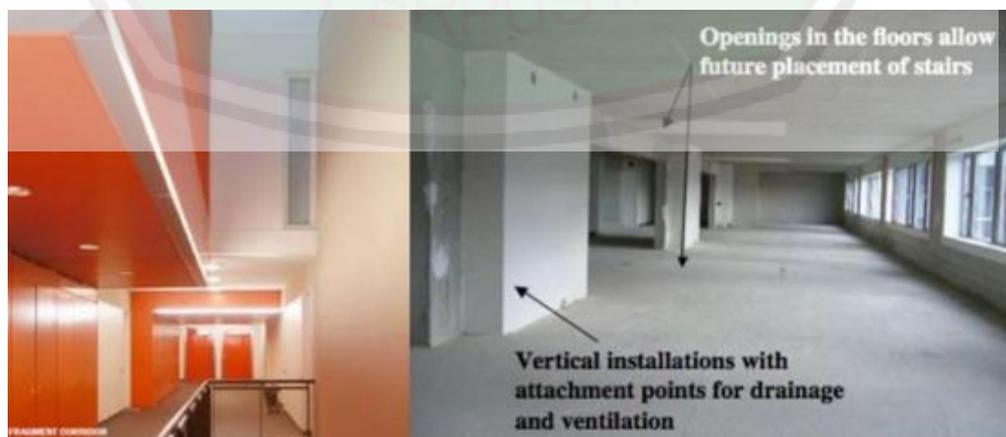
potongan bangunan multifunk (sumber:www.lingotto.nl)
